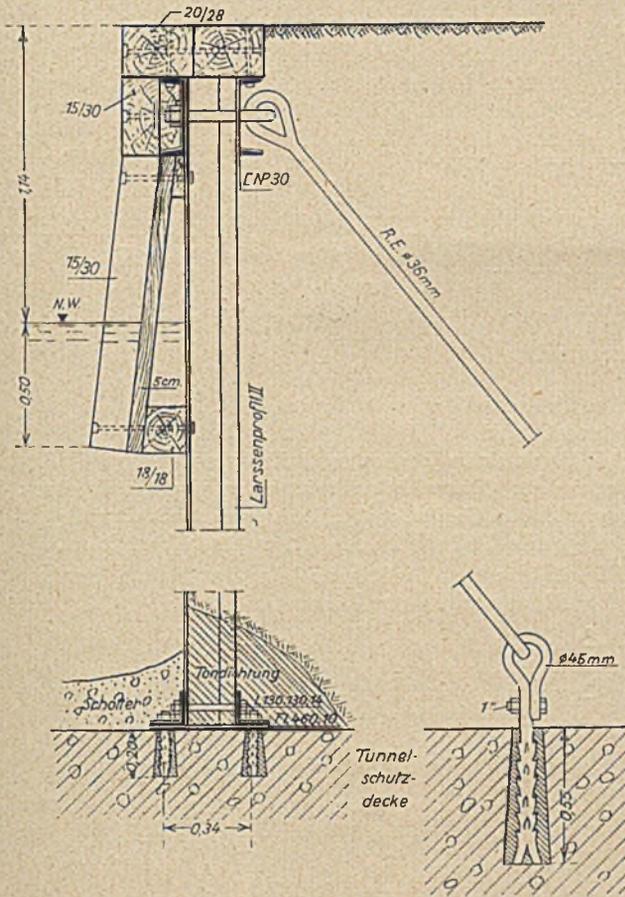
Querschnitt des alten Deckwerks über dem Tunnel.
